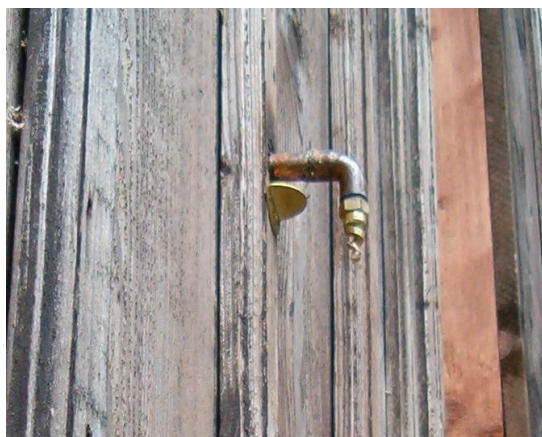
, 7 przedstawia test działania zamontowanej instalacji mgły wodnej wraz ze STHAMEX-em
